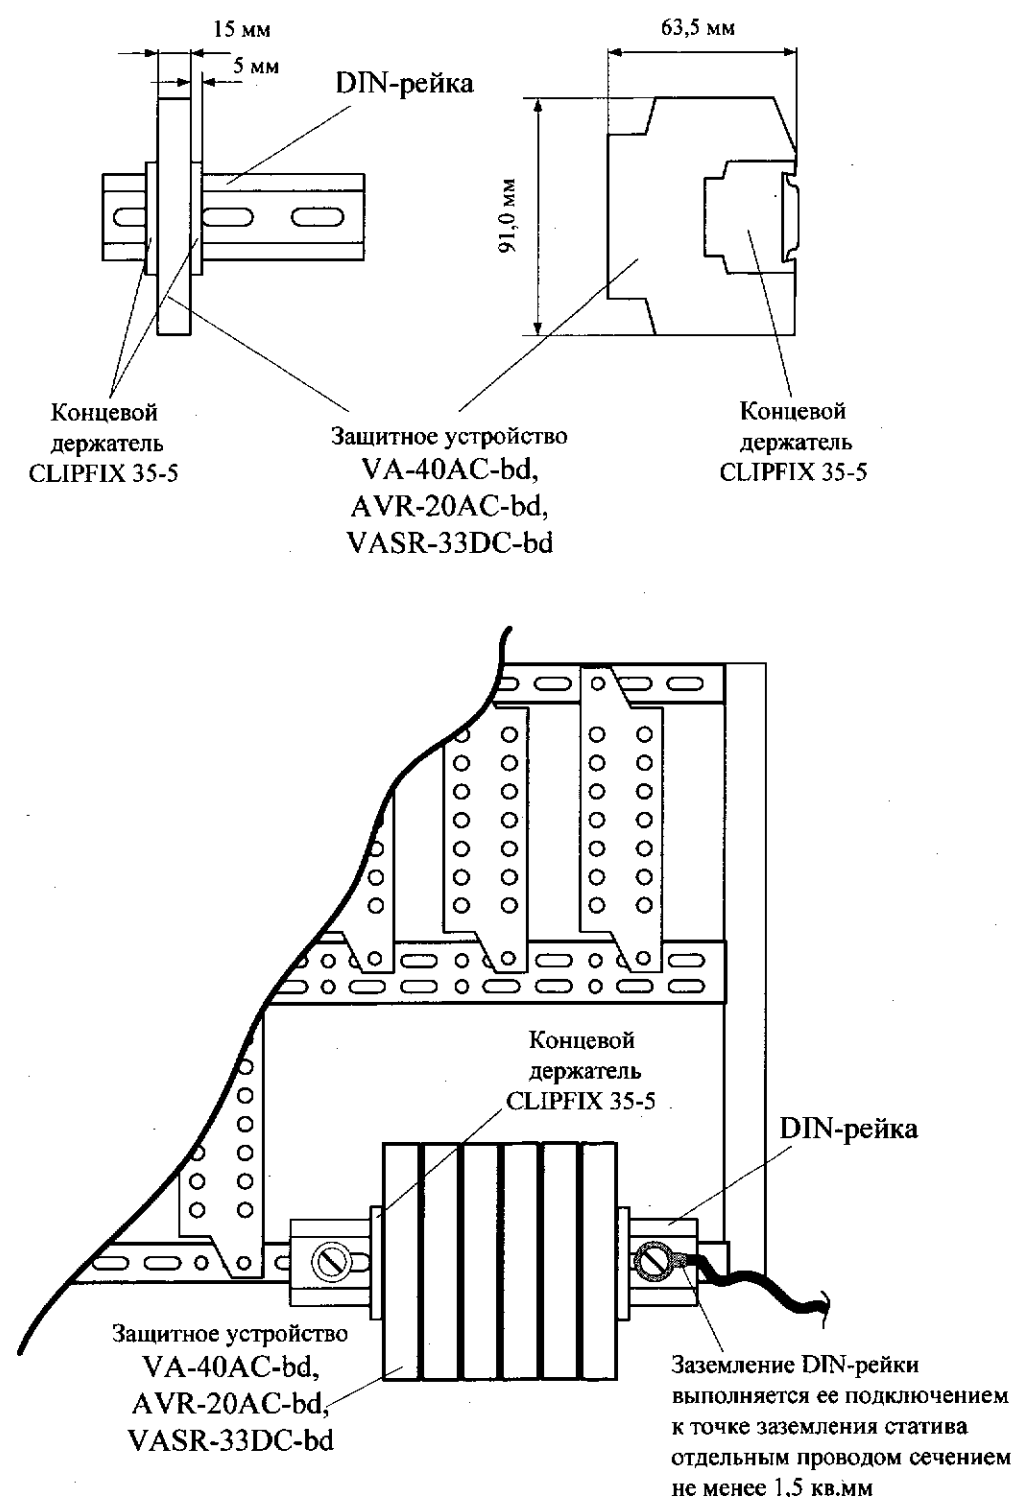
Внешний вид и размещение защитных устройств
